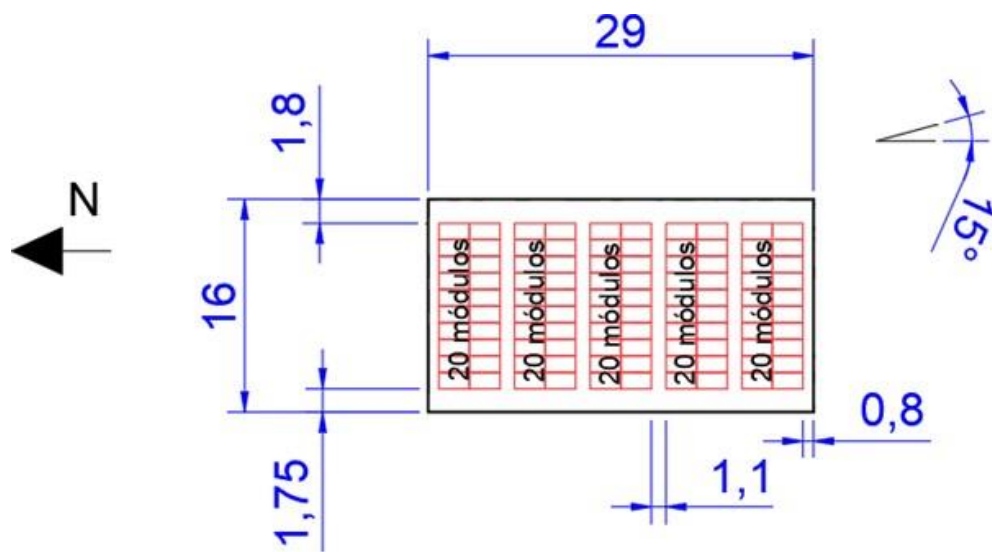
(EESC-Bib) Vista de cima do lugar da instalação com layout dos módulos.
